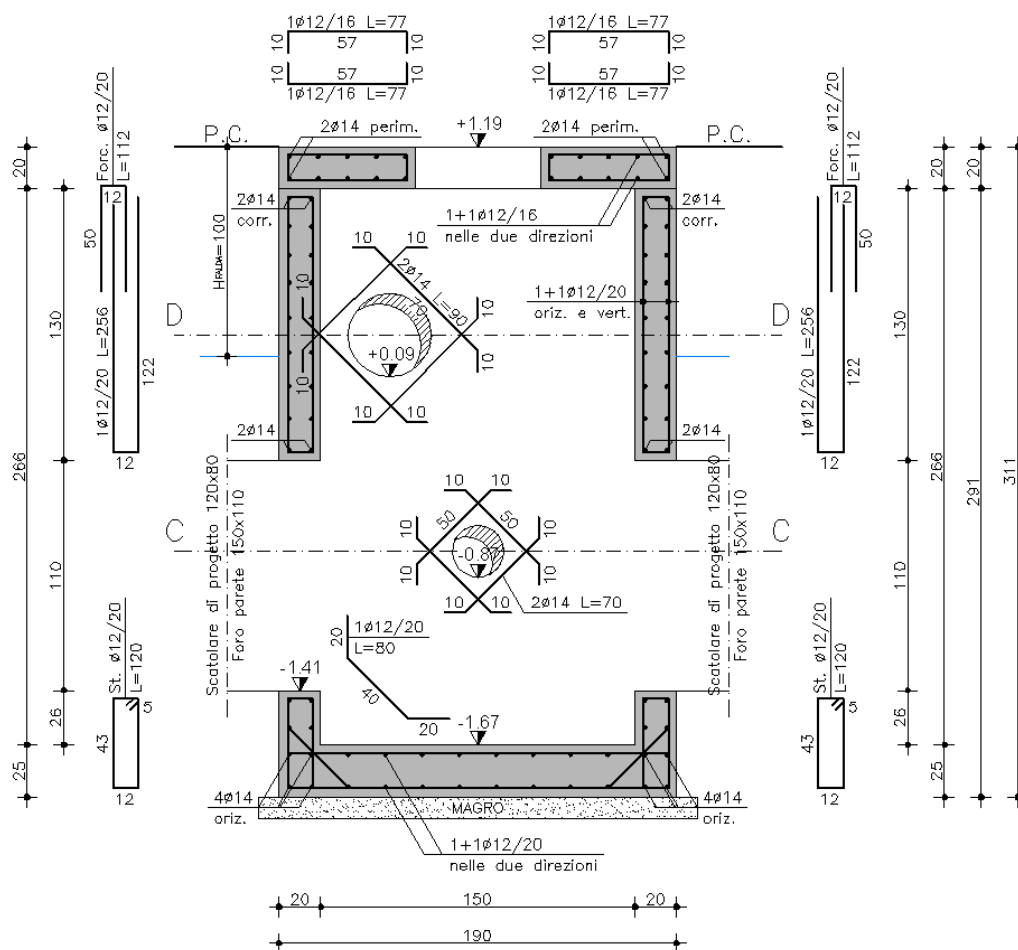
Pozzetto n. 6 - Sezione verticale A-A
